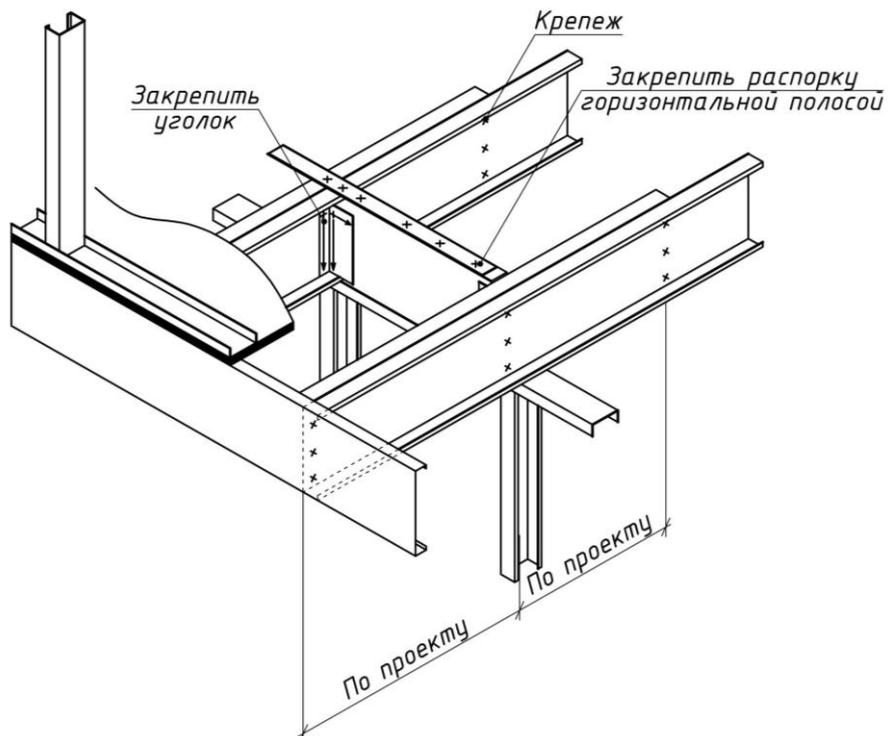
Узел П 18. Крепление опорной балки с колонной
